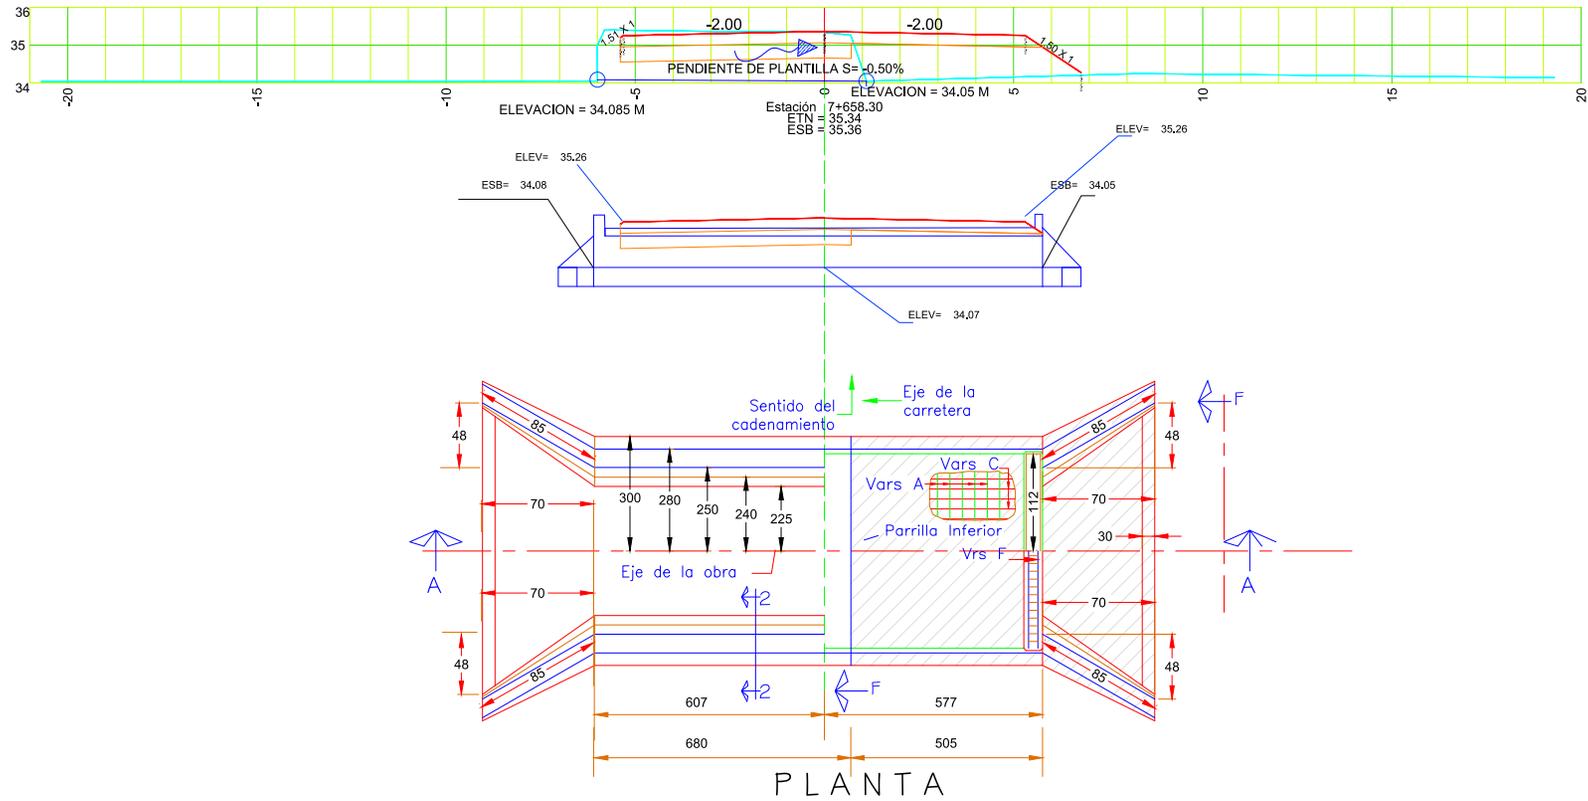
Sección estructural en planta para la construcción de losas de 5 x 1 metros
